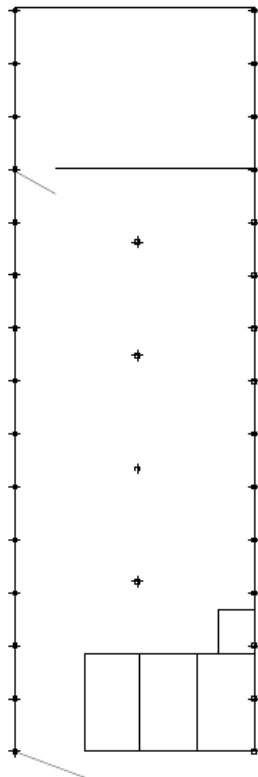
Plano de Planta Sucursal HARICENCA en AutoCAD.
